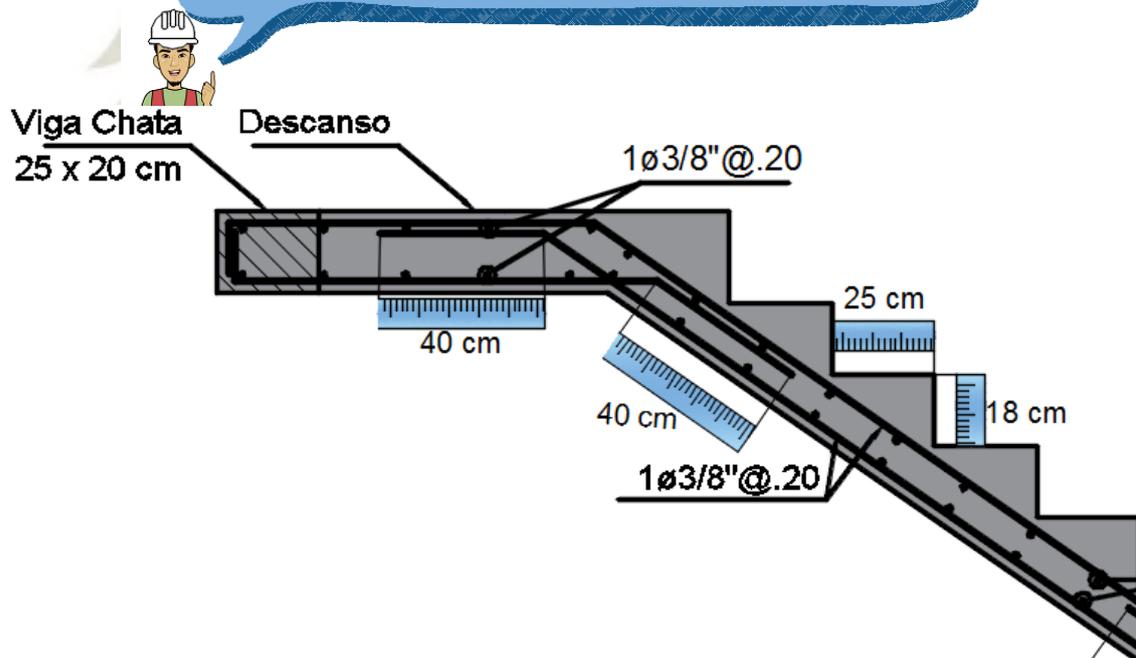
Detalle de acero en la parte superior de tramo de escalera.
